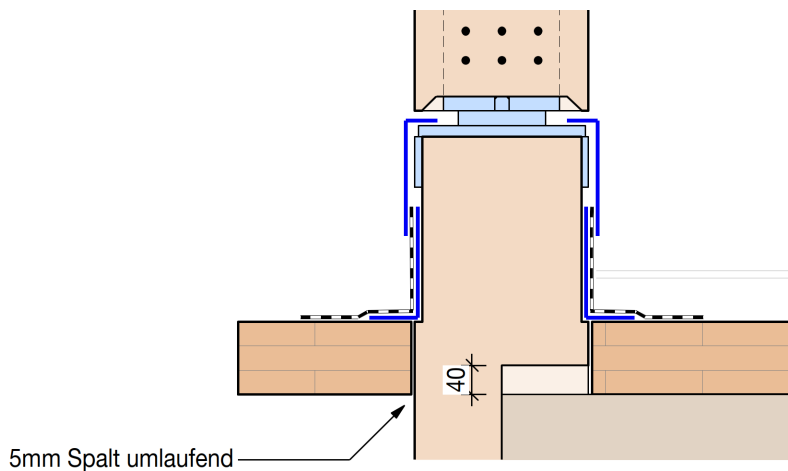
Detailschnitt Anschluss Stütze an Zwischendecke
